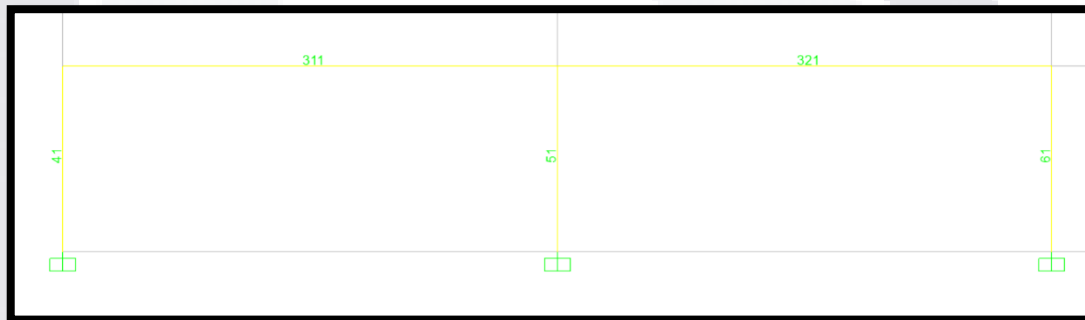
Marco en eje "B", con vigas y columnas del nivel 1º.
